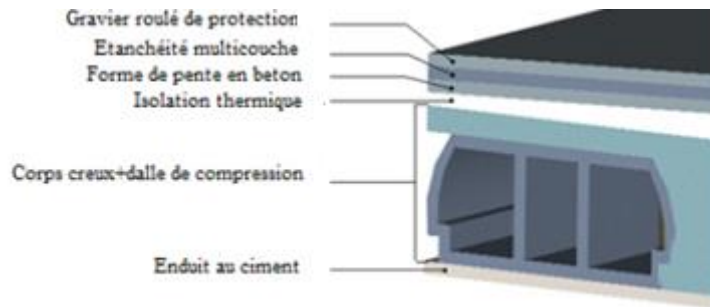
DISPOSITION DES MATERIAUX POUR PLANCHERS A CORPS CREUX
